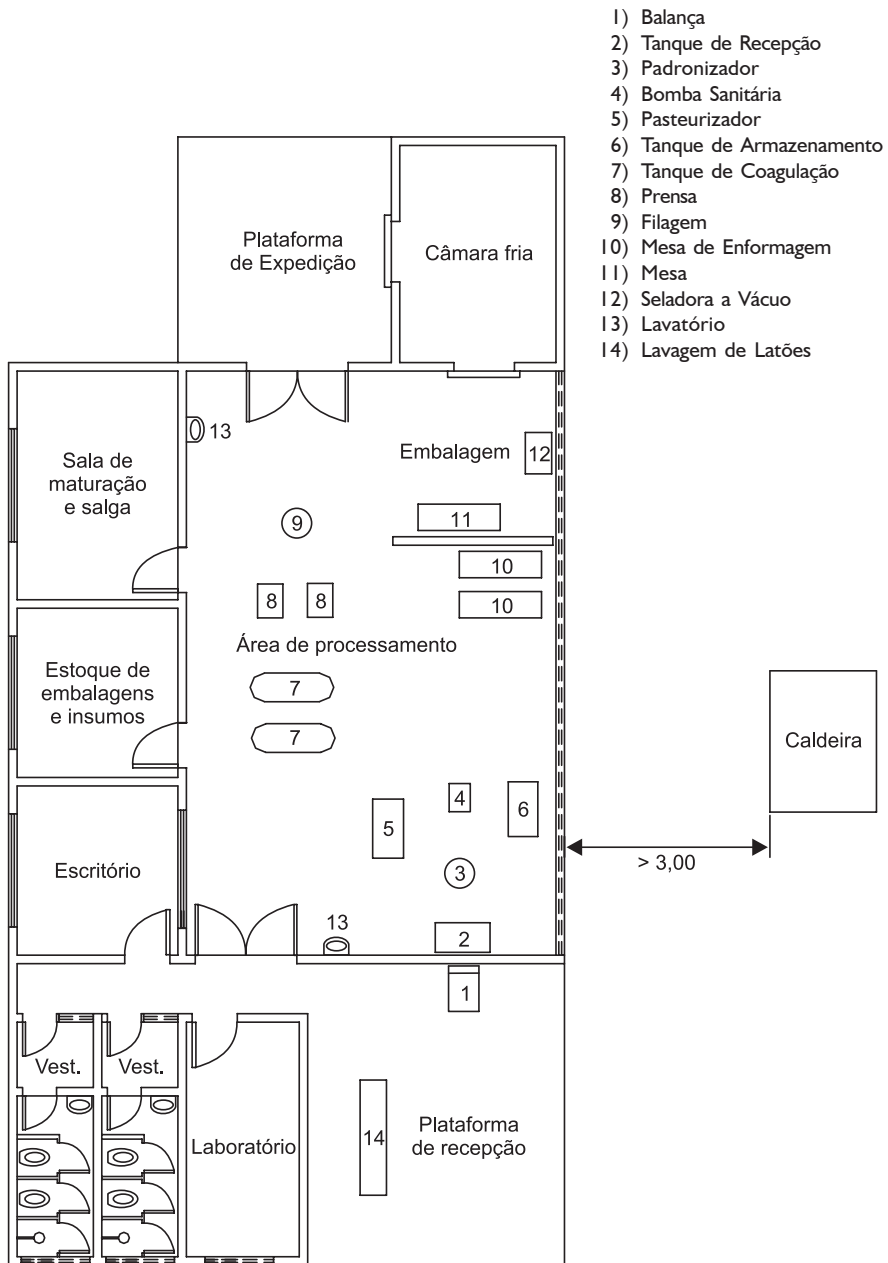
Planta baixa da agroindústria de queijo parmesão.
